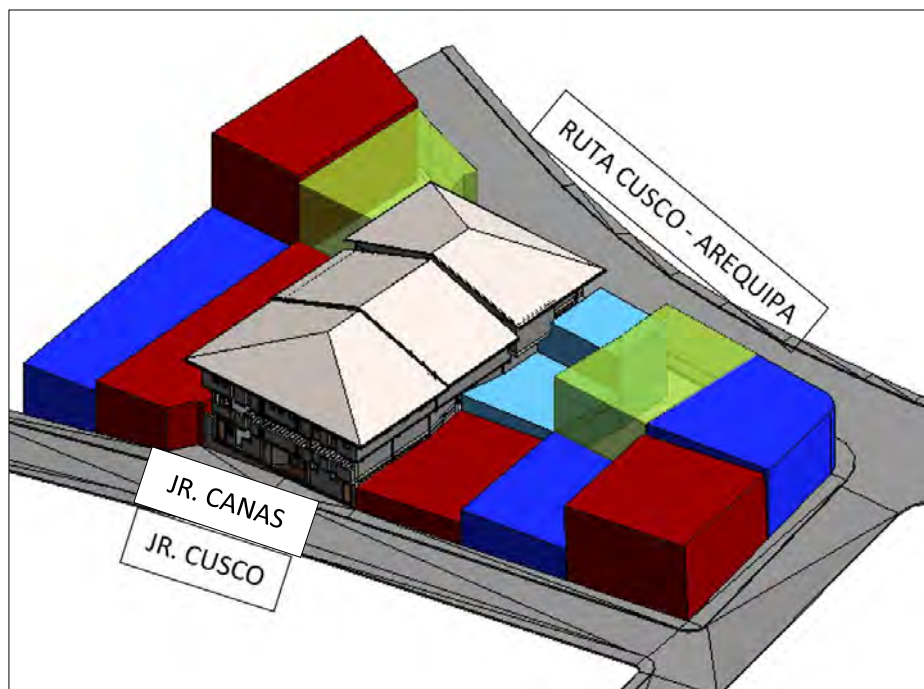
Modelado de Infraestructura Existente. Vista 3D.
